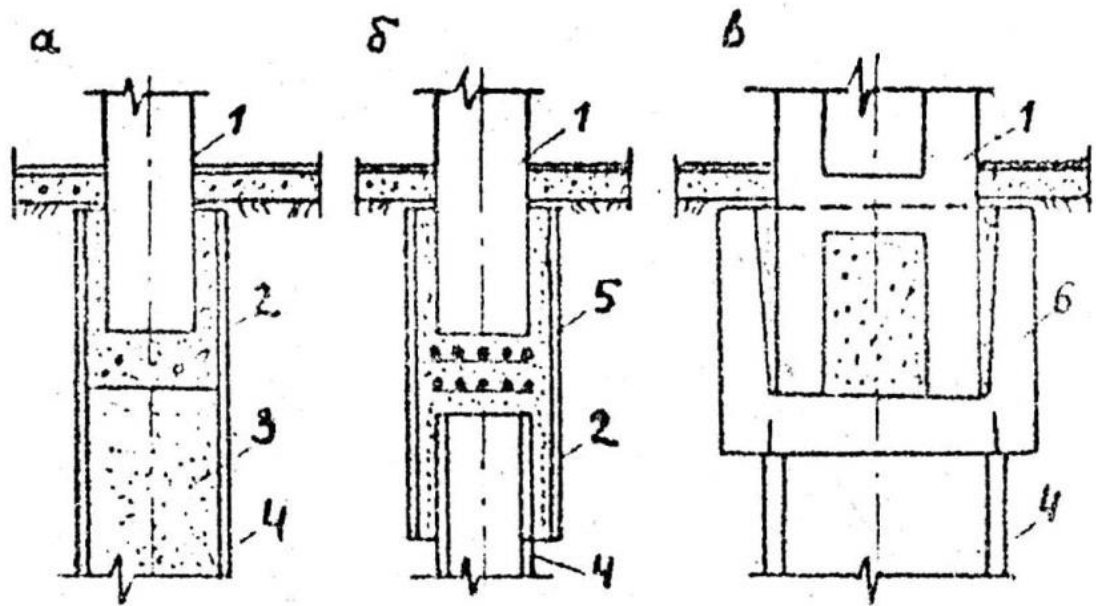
Сопряжение полый круглой сваи и сваи-оболочки с колонной:
